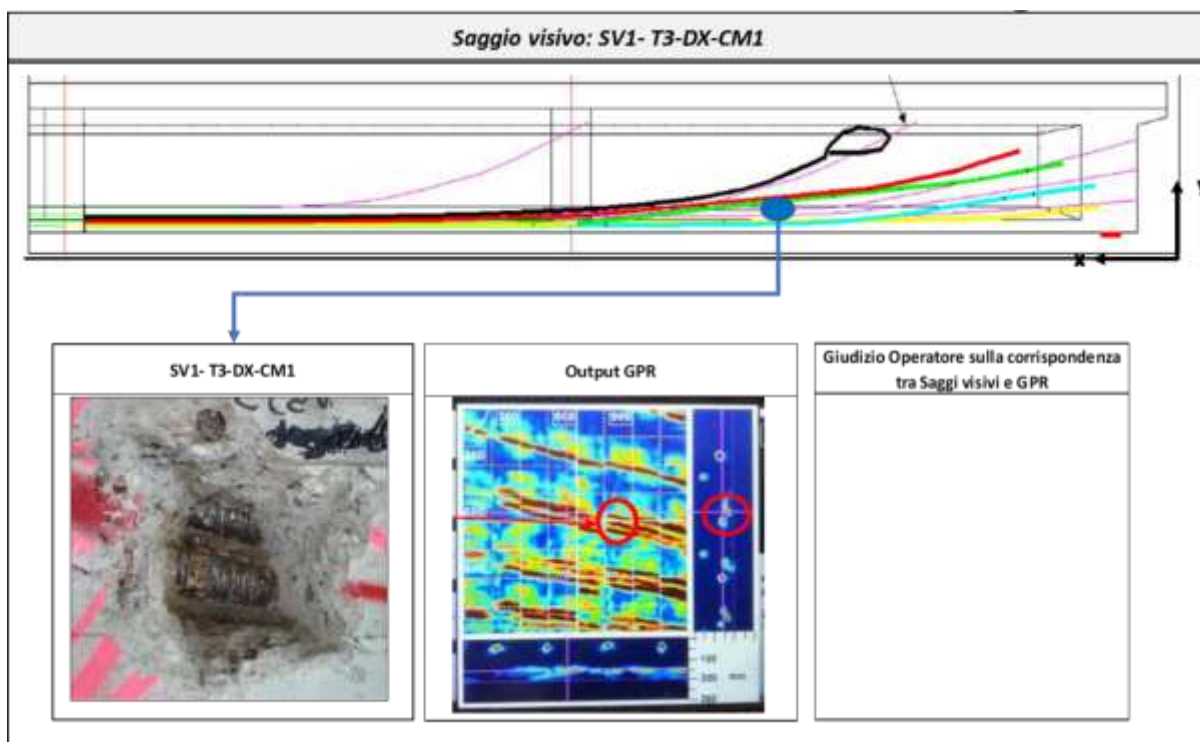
Profilo longitudinale trave con sovrapposto l'andamento dei cavi – Prove Georadar
